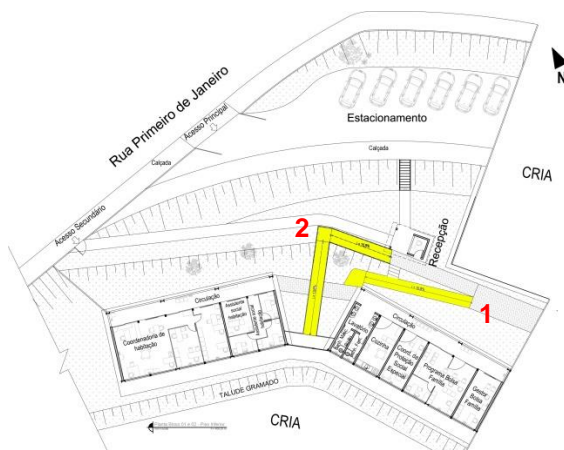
Planta baixa do 1º pavimento com rampas destacadas. Fonte: Adaptado pela autora com base em projeto cedido pela Secretaria de Obras.
